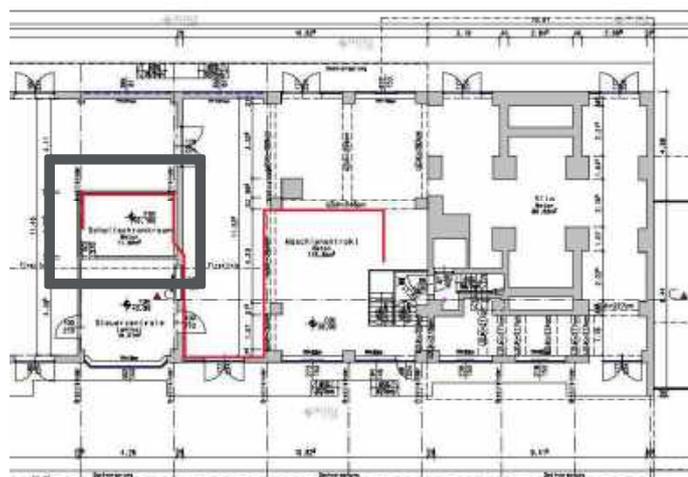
Grundriss Kabelführung in den Technikraum (Blau)
